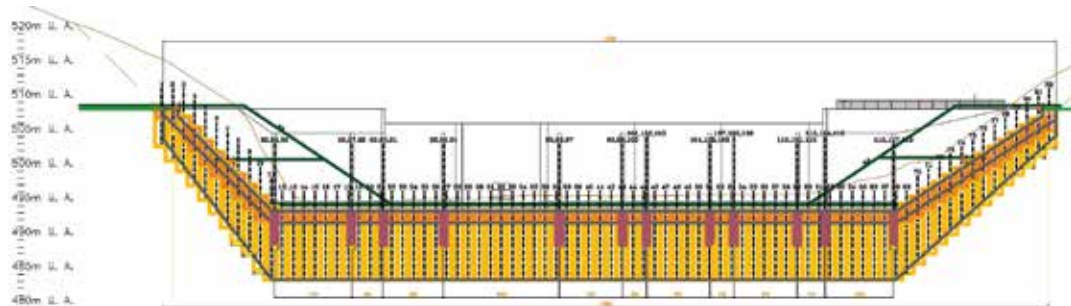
Plan zu Lage und Tiefe des Dichtschirms (Keller Grundbau, 2015)
